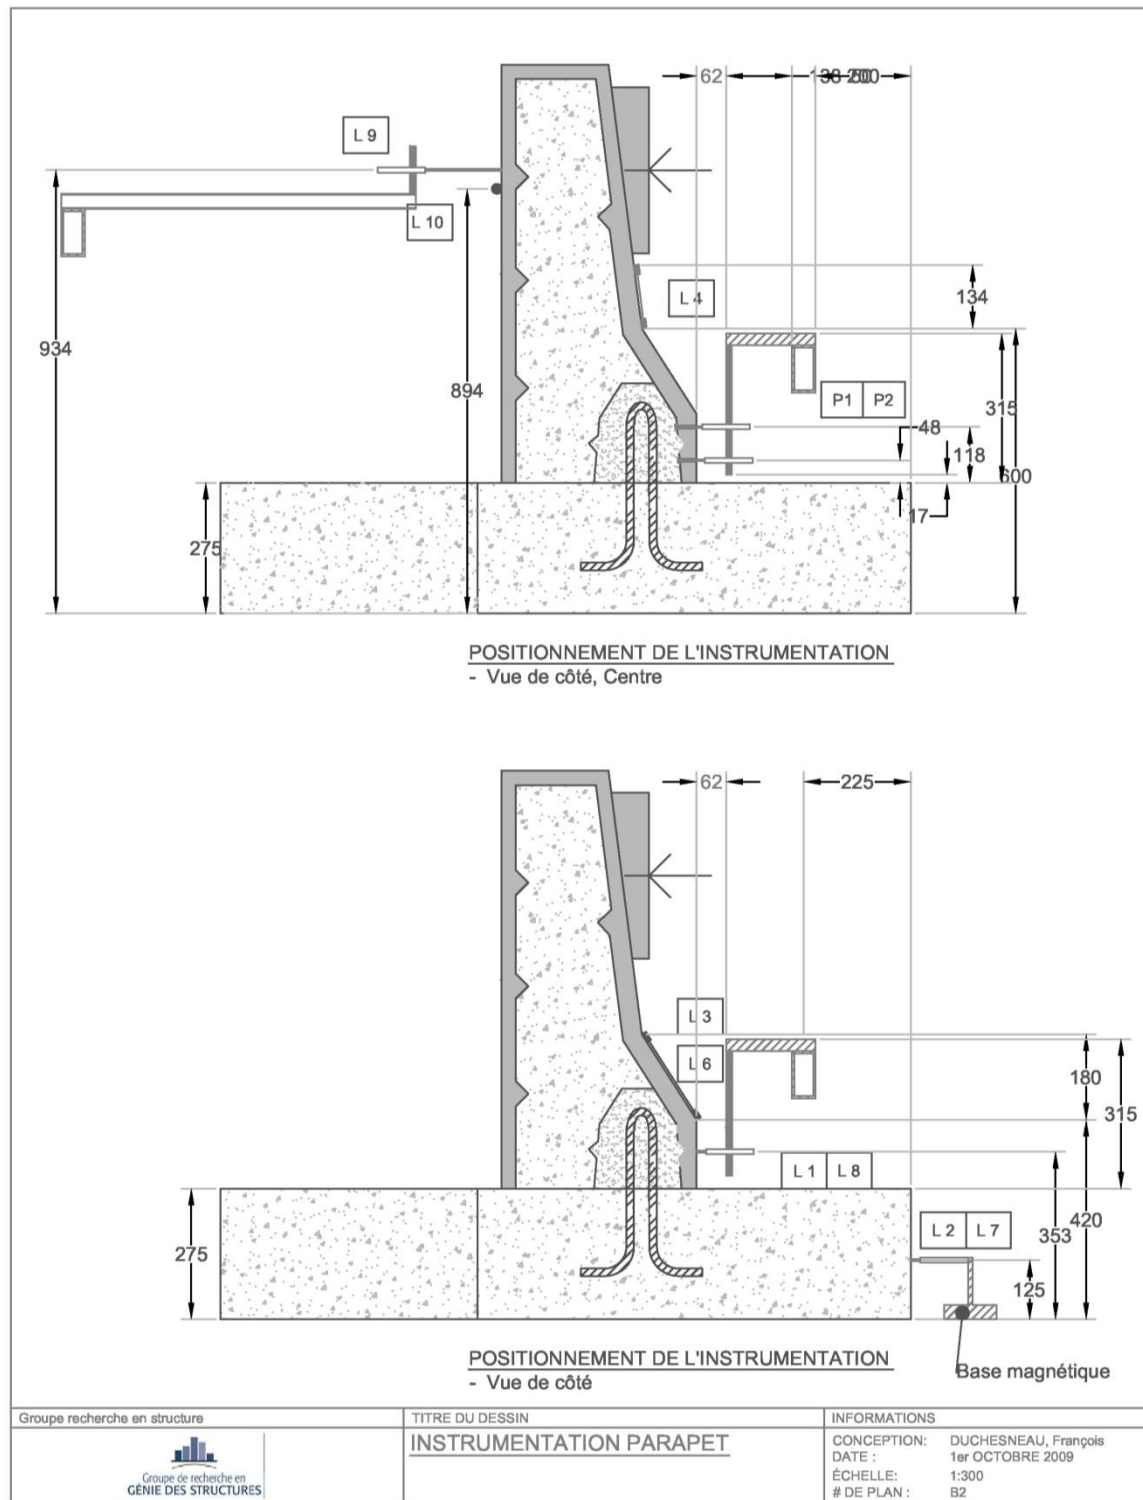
Plan d'instrumentation des parapets, vue de profil
